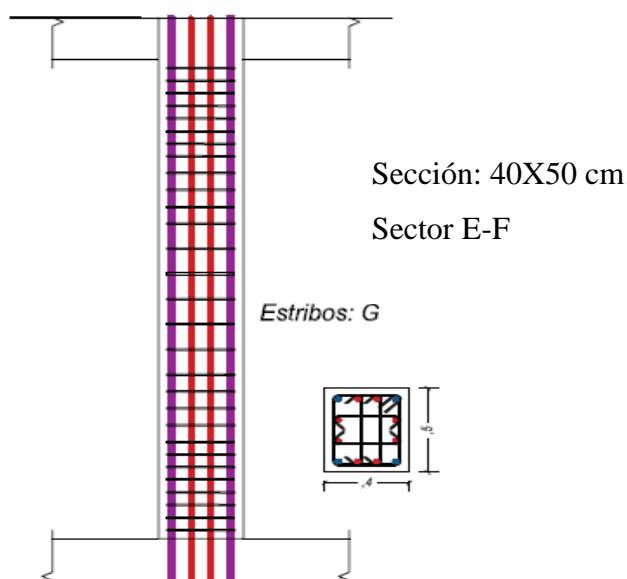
Detalle de Columna en Base Aislada (E-F)
